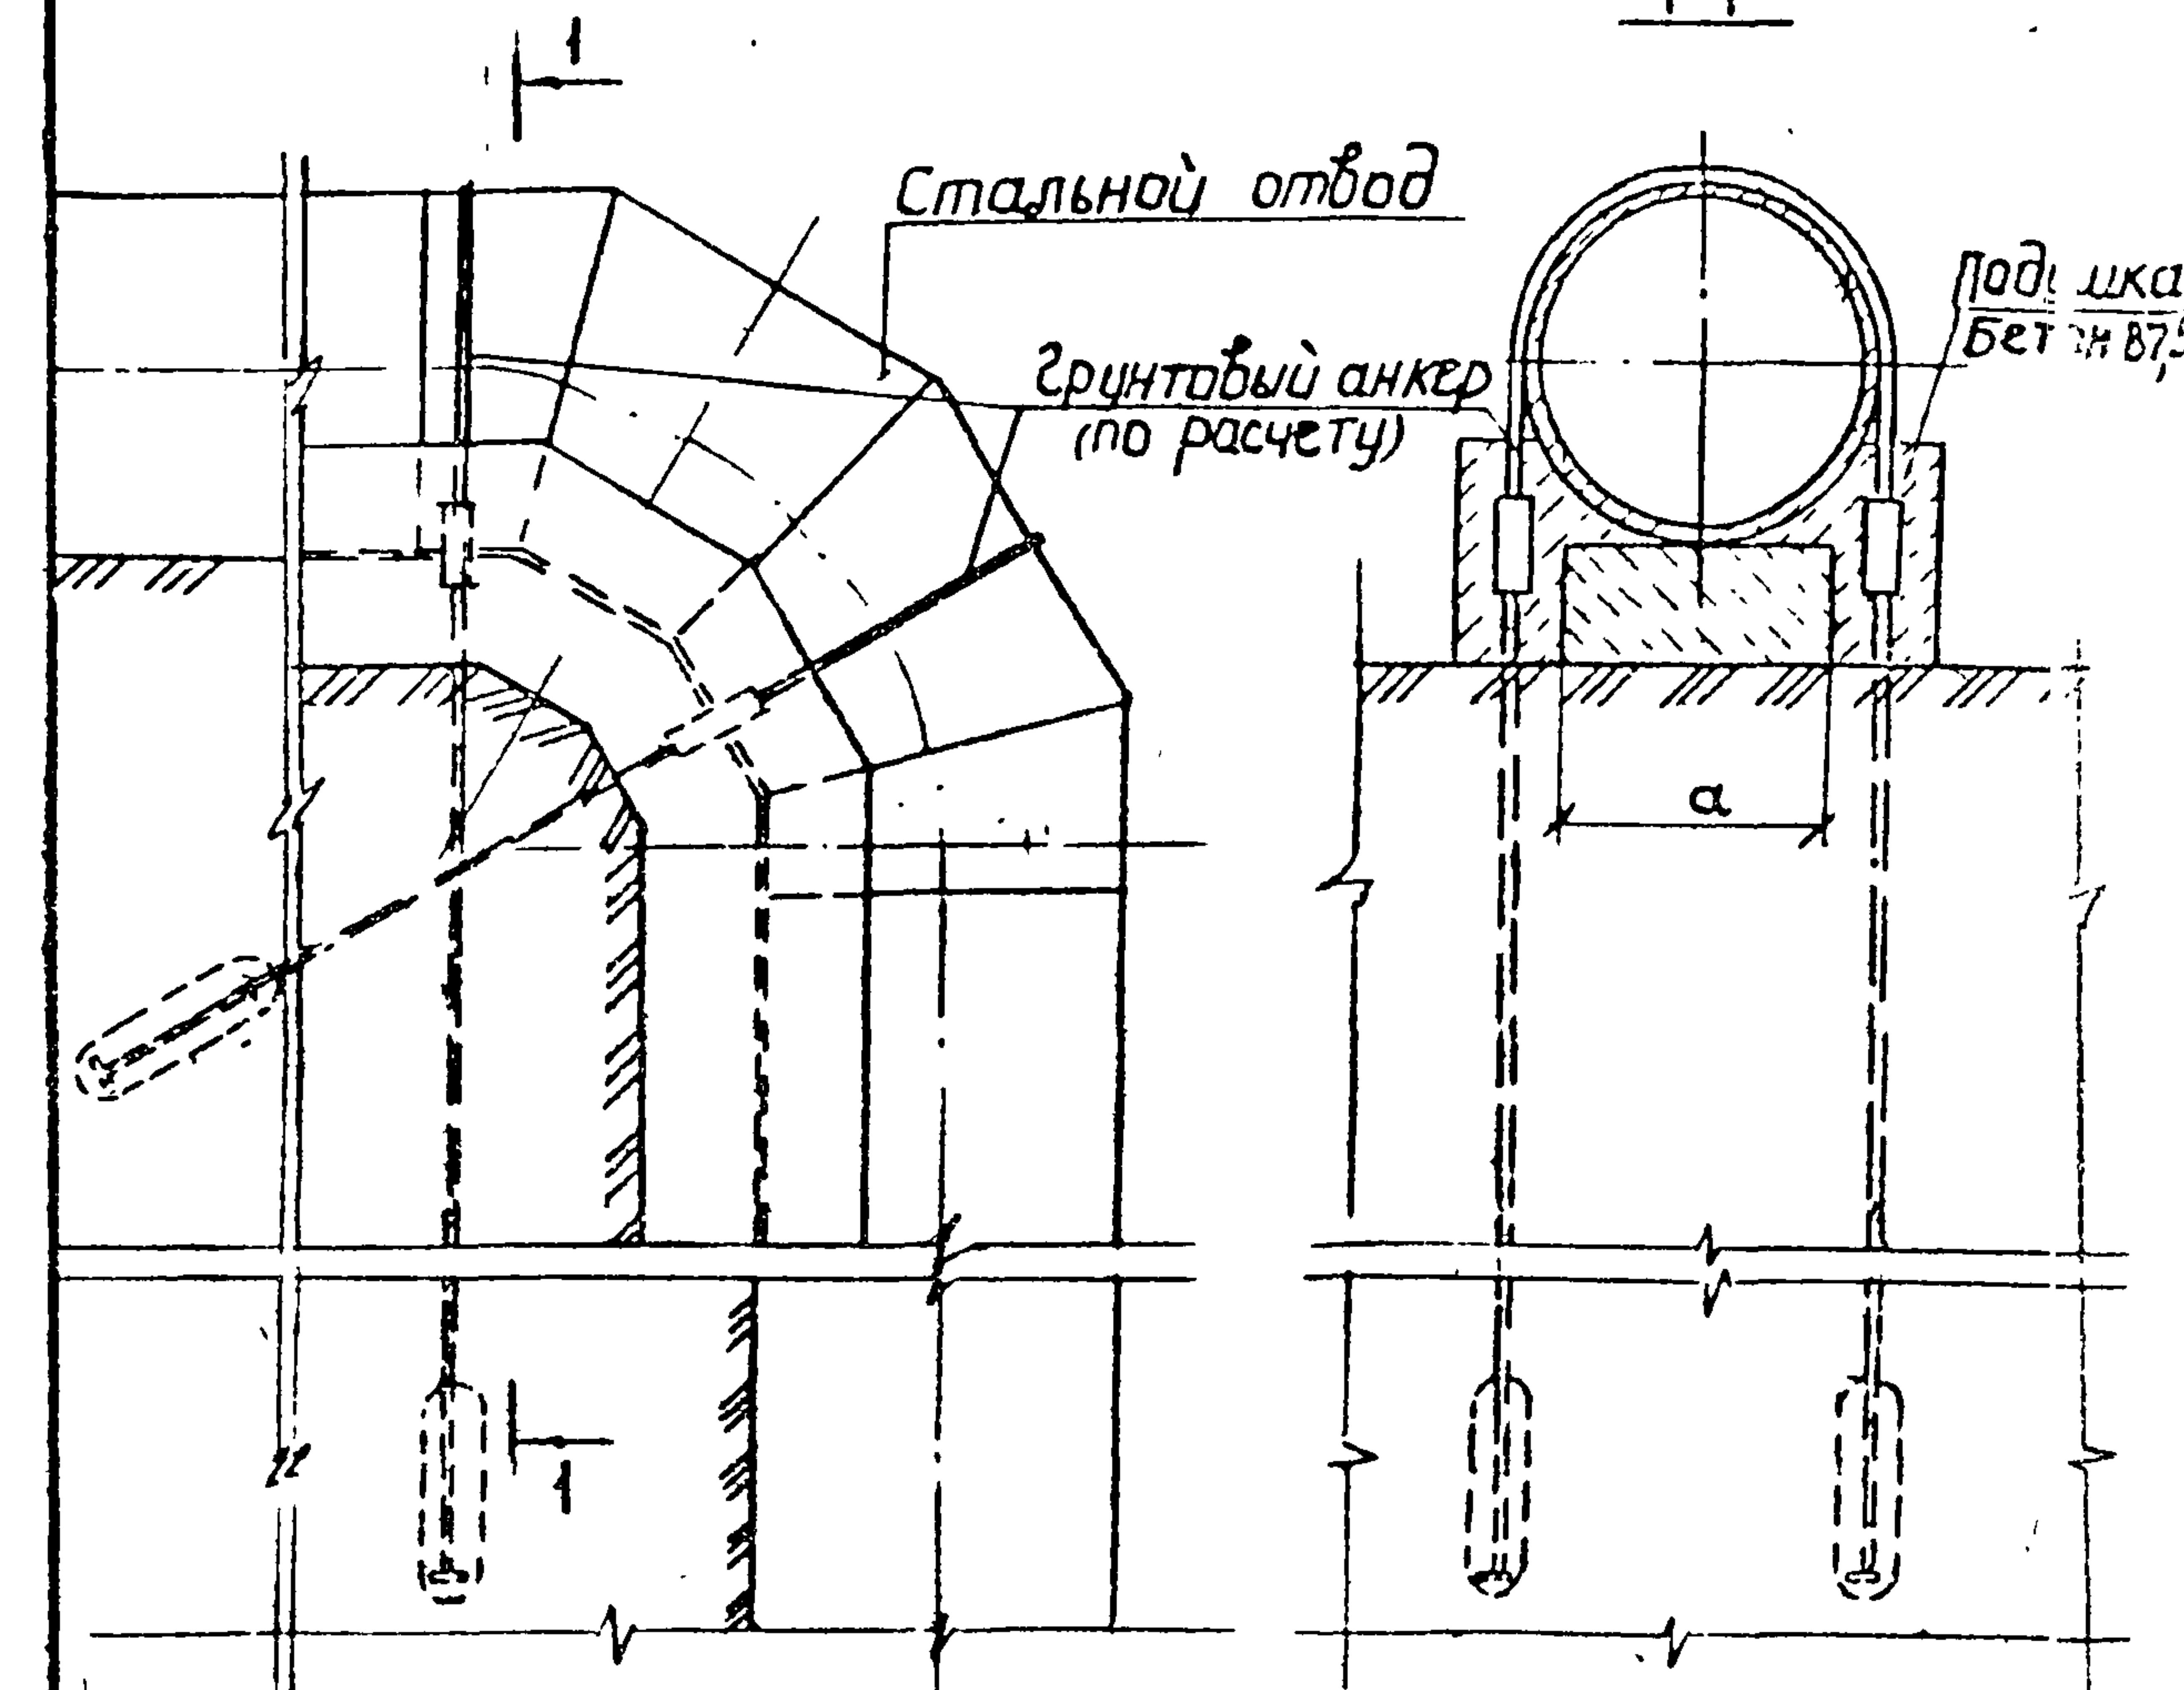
Вертикальный верхний упор для трубопровода с использованием грунтовых анкеров.
